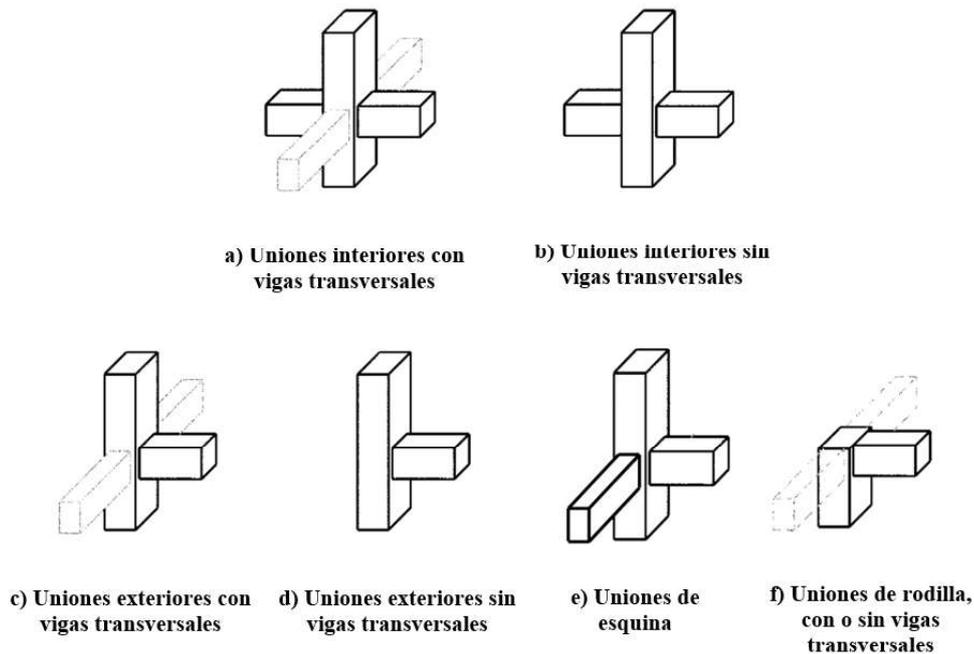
Clasificación de uniones viga columna
